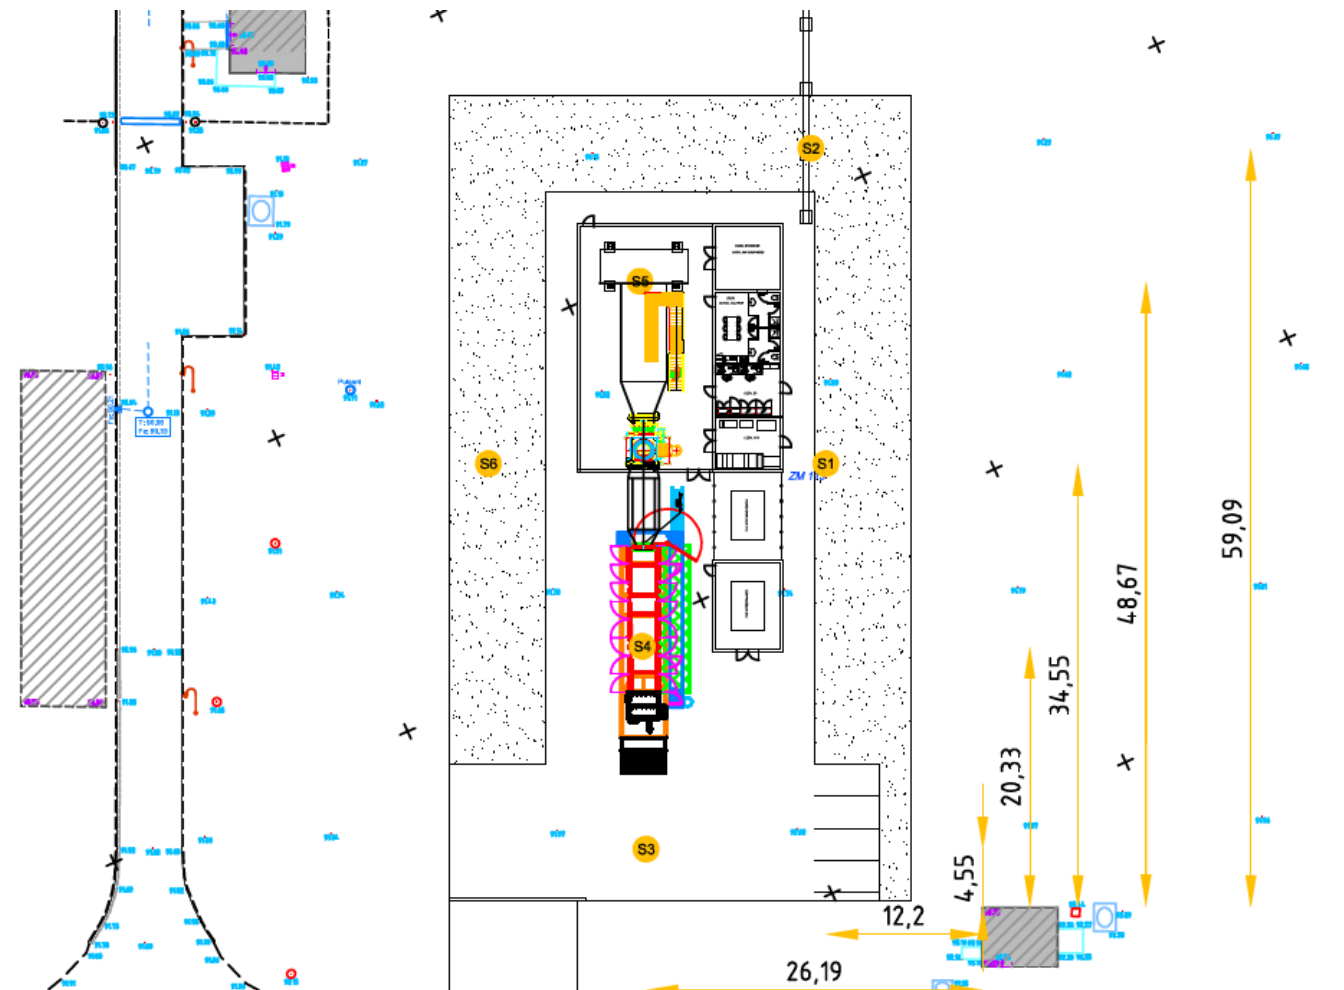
extrait du plan de masse (source DALKIA, décembre 2016)
